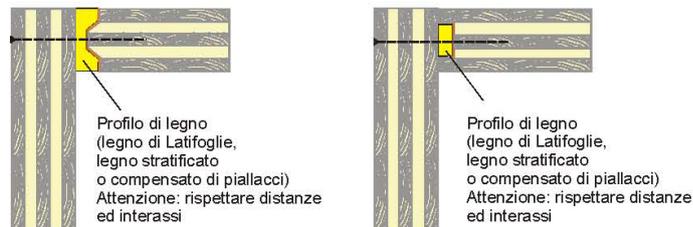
Giunzione parete-solaio-parete, bullonatura del legno di testa da evitare
